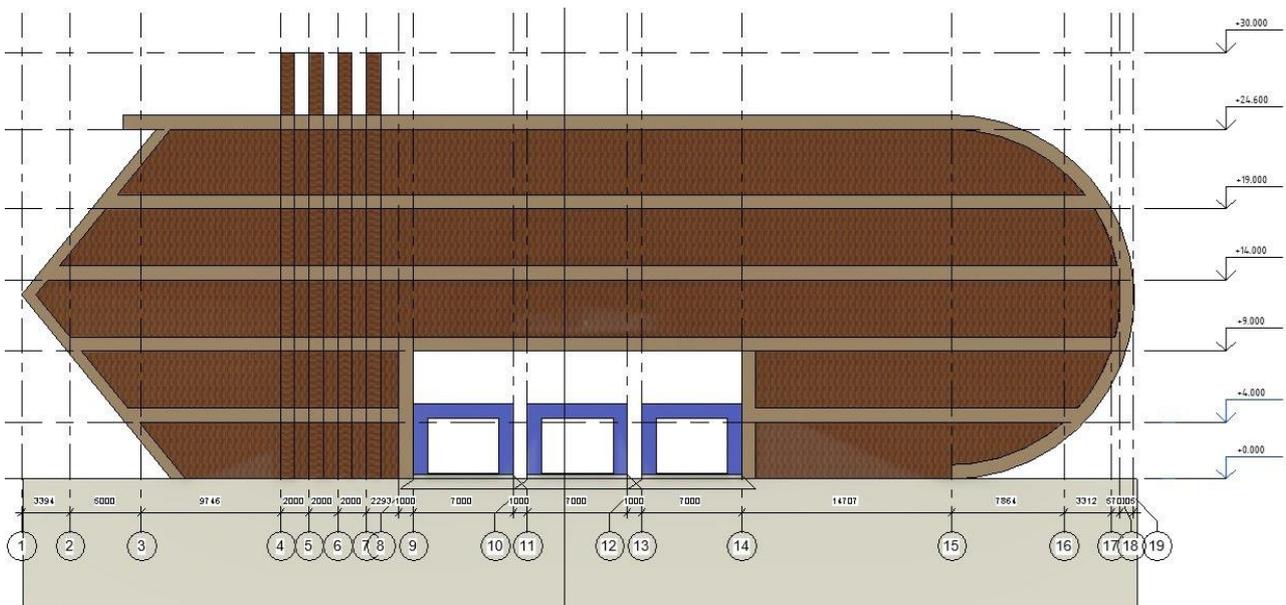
Разрез фасада в осях 1-19 по оси А
